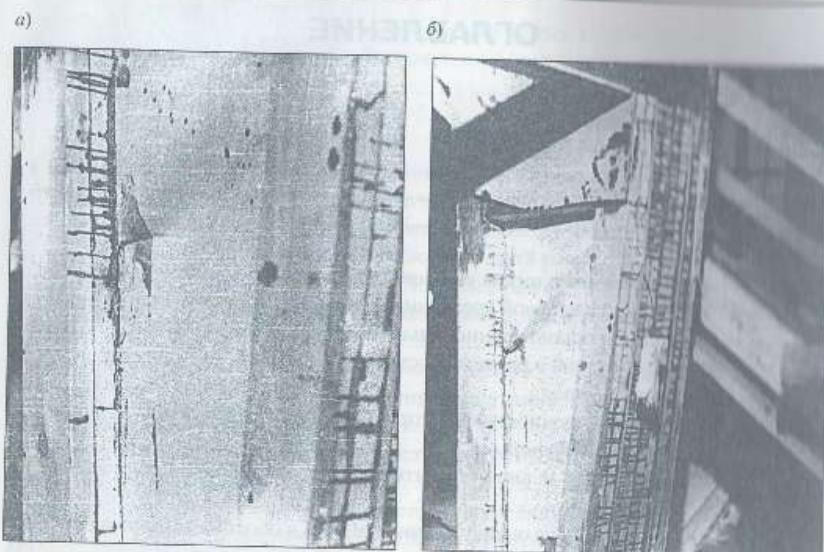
Развитие складки в фанерной стенке стойки рамы КФР-18г-1: а - начальная стадия образования складки и волны в стенке; б - окончательный характер разрушения фанерной стенки в стойке рамы
